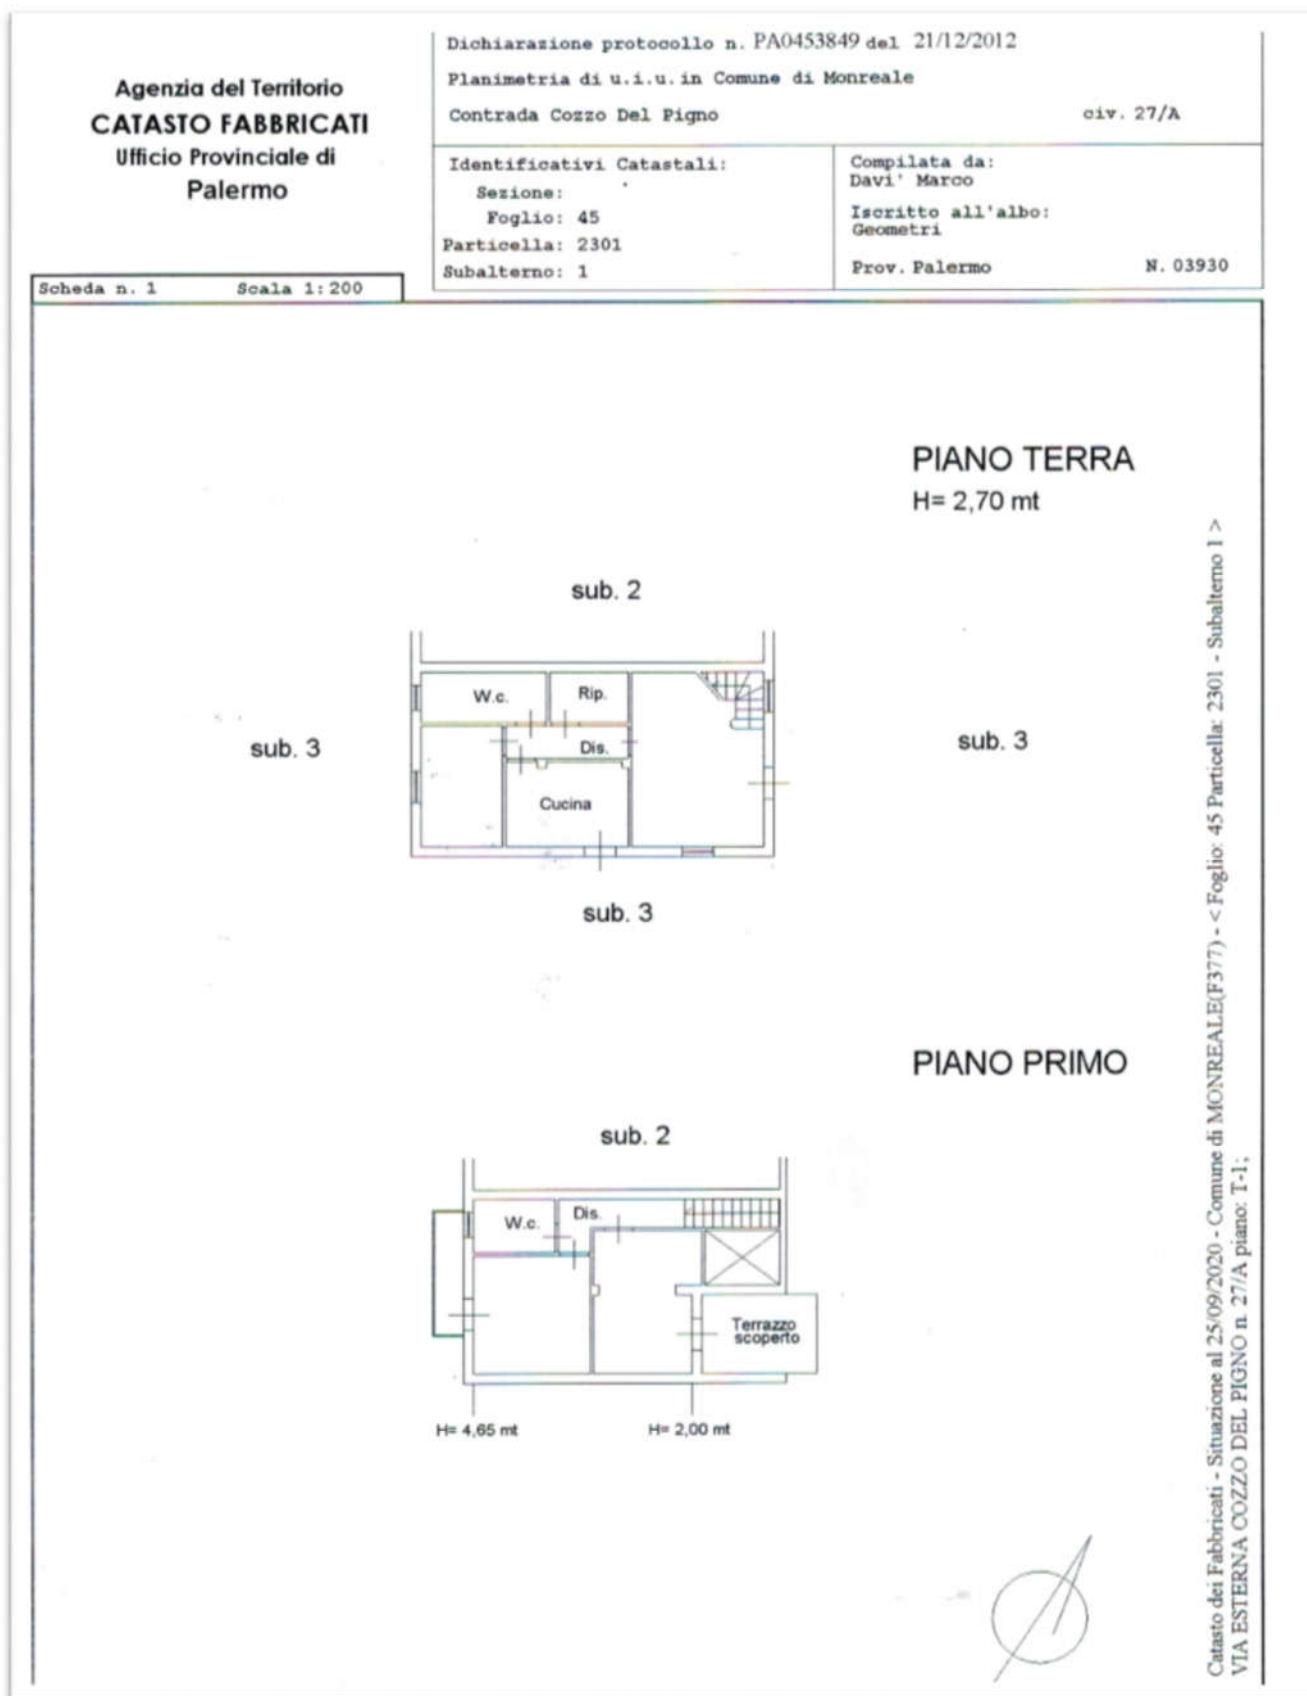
Planimetria catastale p.lla 2301 sub 1
